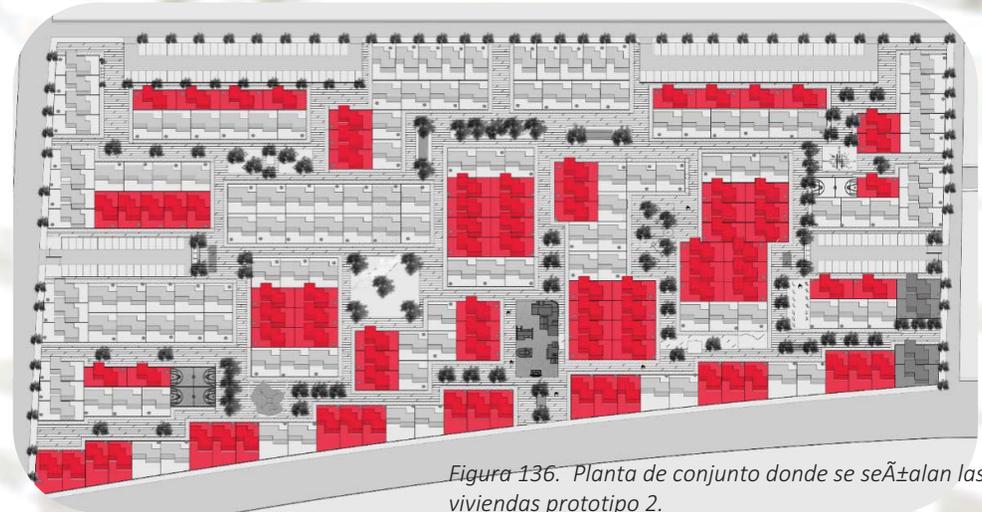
Planta de conjunto donde se señalan las viviendas prototipo 2.
